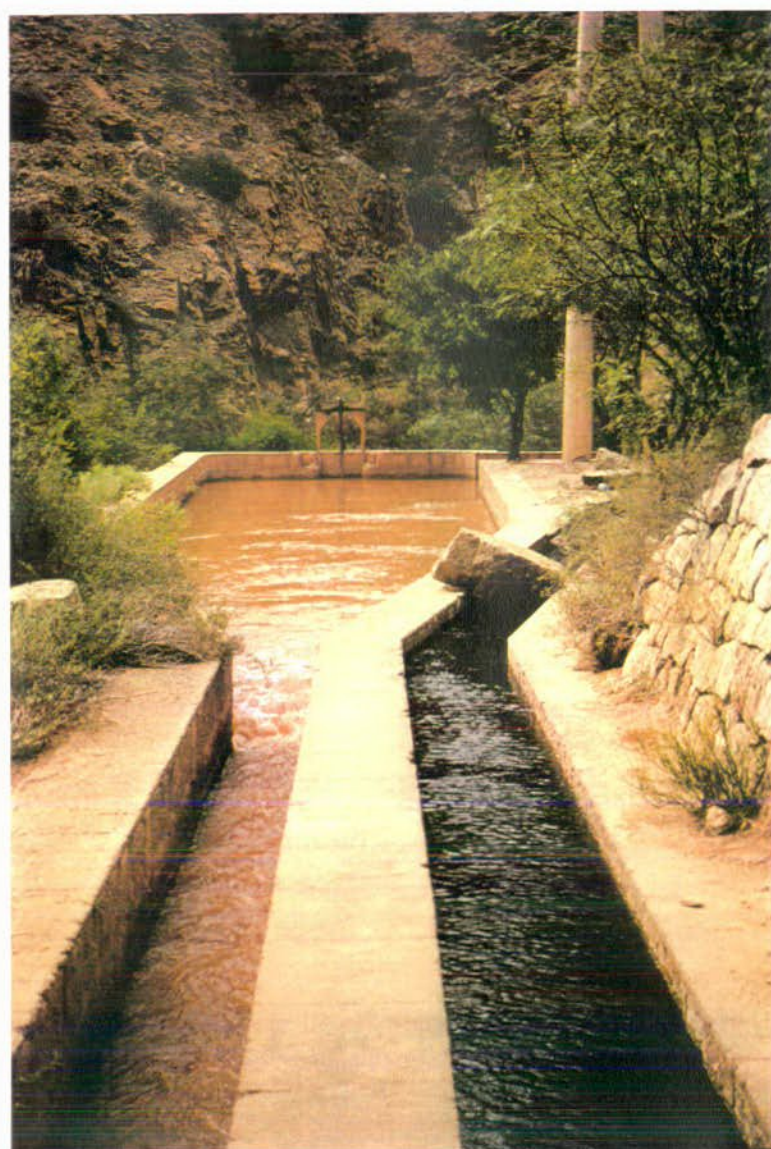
Vista de la Planta Potabilizadora de Villa Mazán, ubicada sobre la R.N.N° 60 a la entrada de la localidad.
